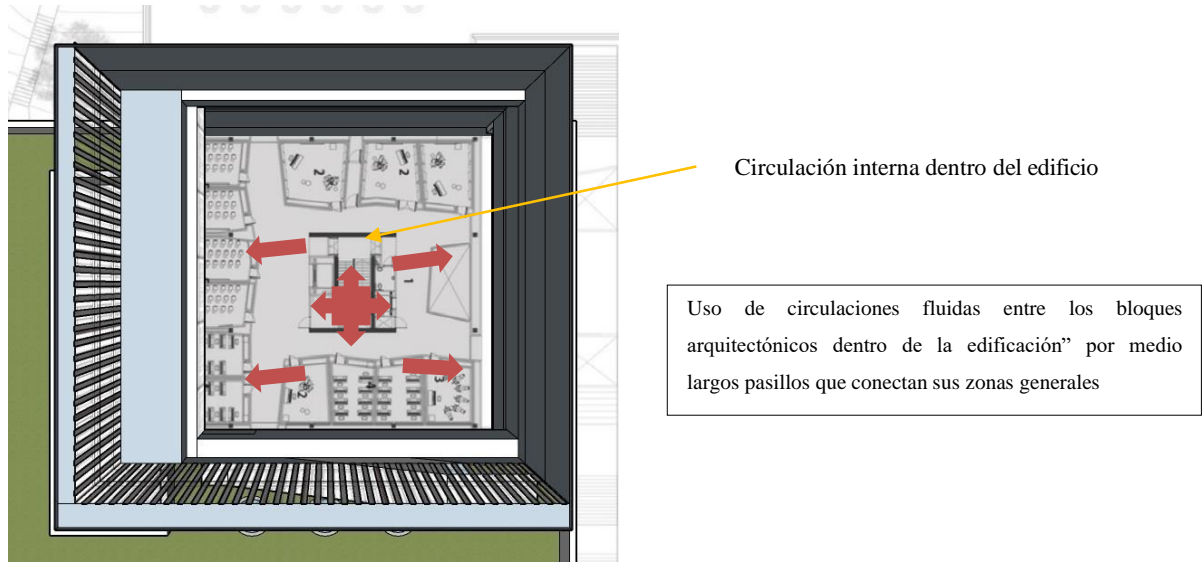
Vista isométrica de planta del edificio-ISOMETRIA 3
